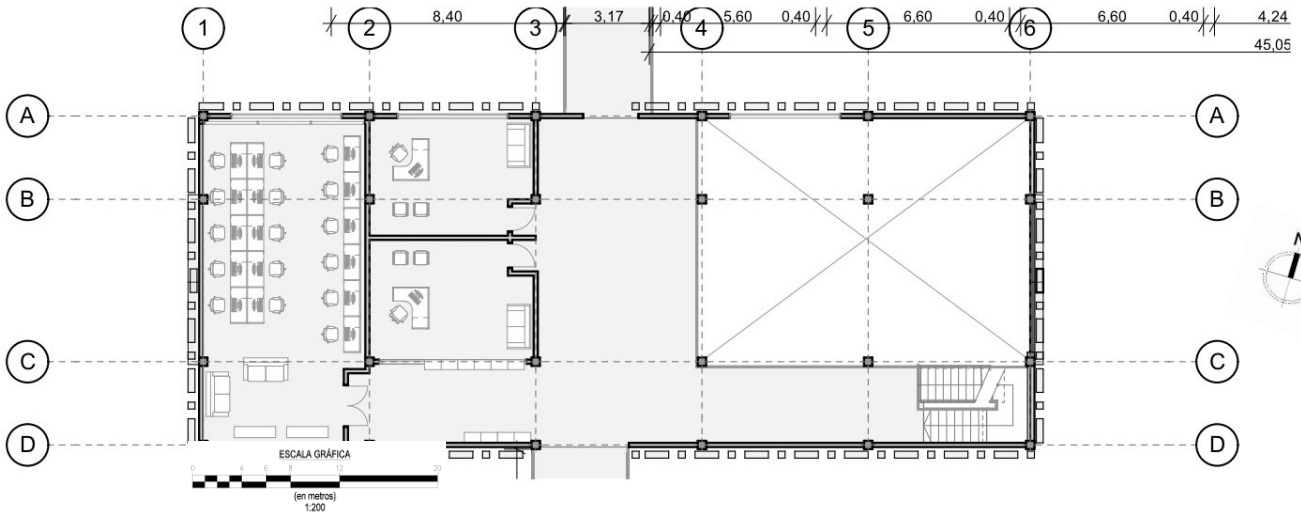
Plano segundo nivel - bloque B / Fuente: Propia
